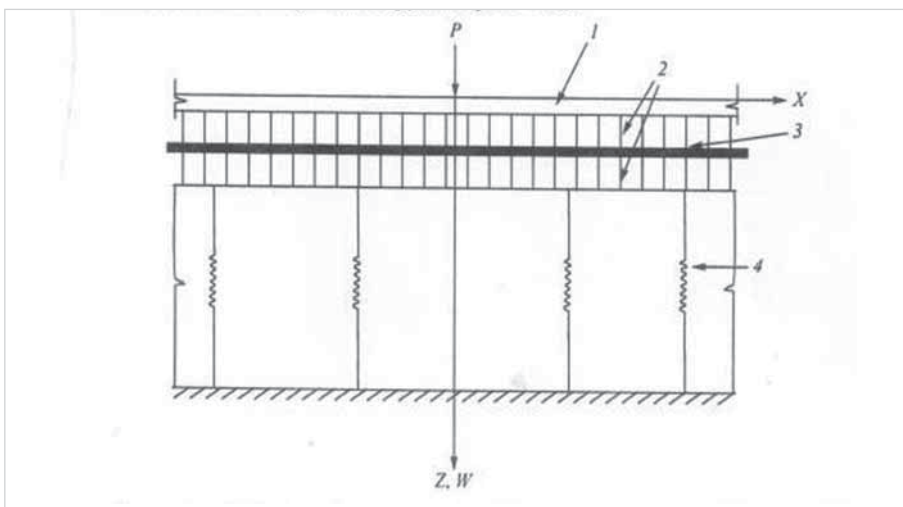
Механическая модель балки на многослойном основании. 1 – бесконечная балка; 2 – слои Пастернака, работающие на сдвиг; 3 – армирующая прослойка (если требуется); 4 – пружины основания Винклера [1]
